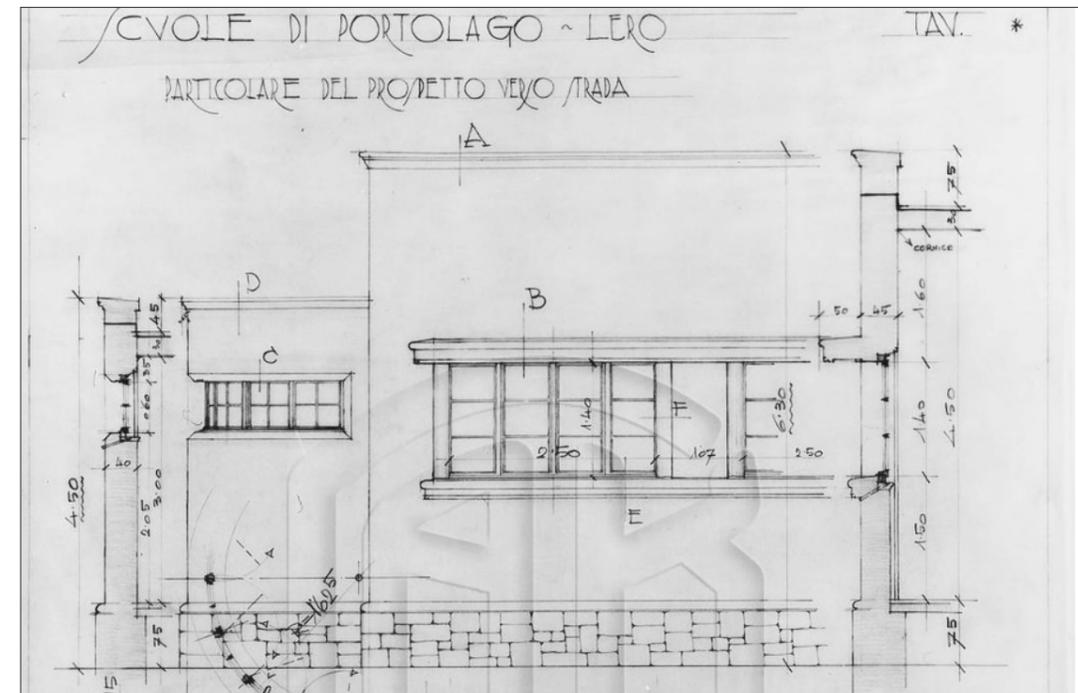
scuola, part. prospetto lato strada, sc. 1:20
